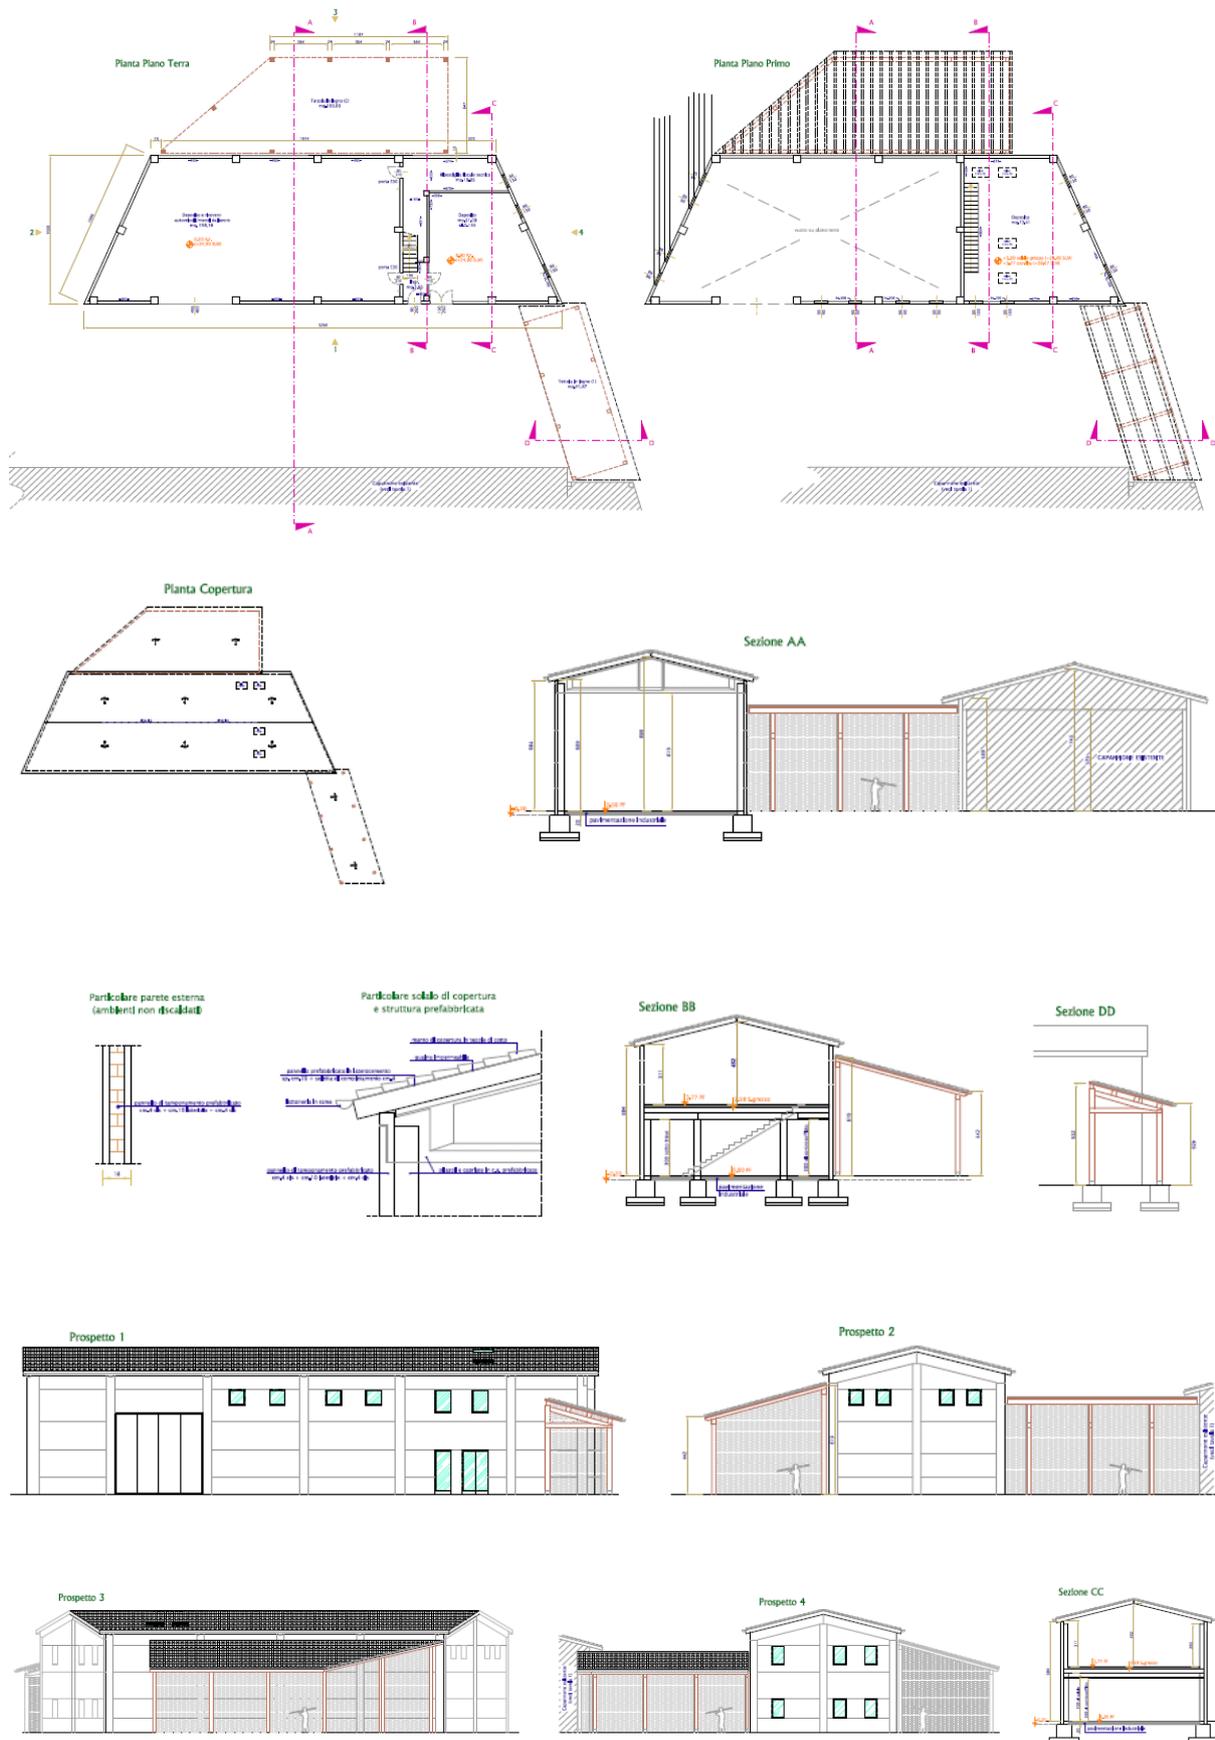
Estratto Tavola 2 - Stato modificato – Piante Sezioni e prospetti
